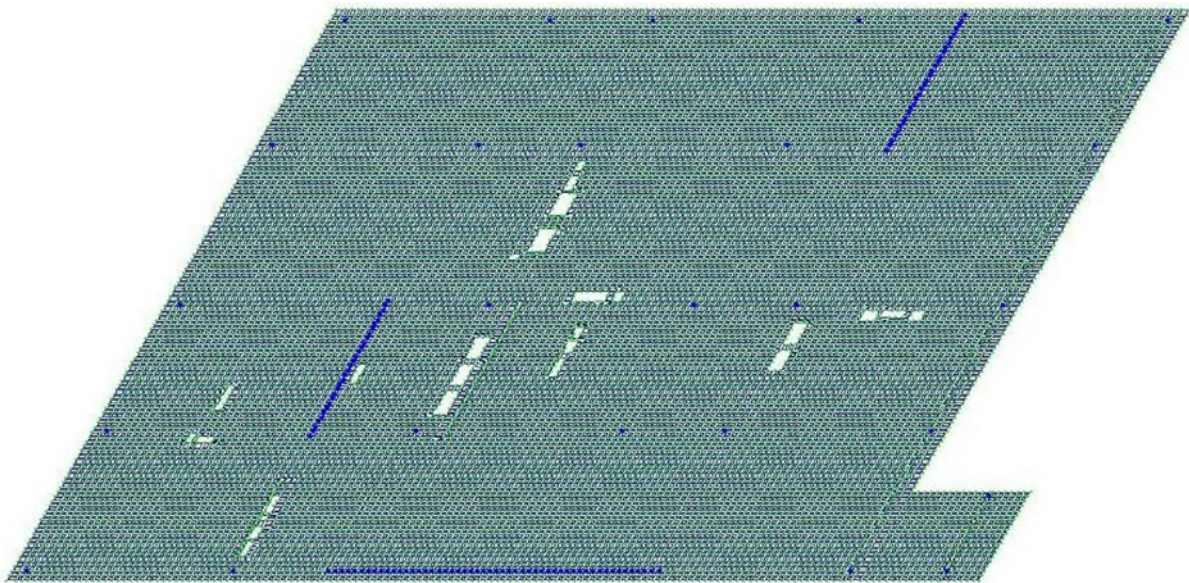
Розрахункова схема плити перекриття над 8 поверхом блоку Б в осях 1б-6б / Жб-А_{6/7}
